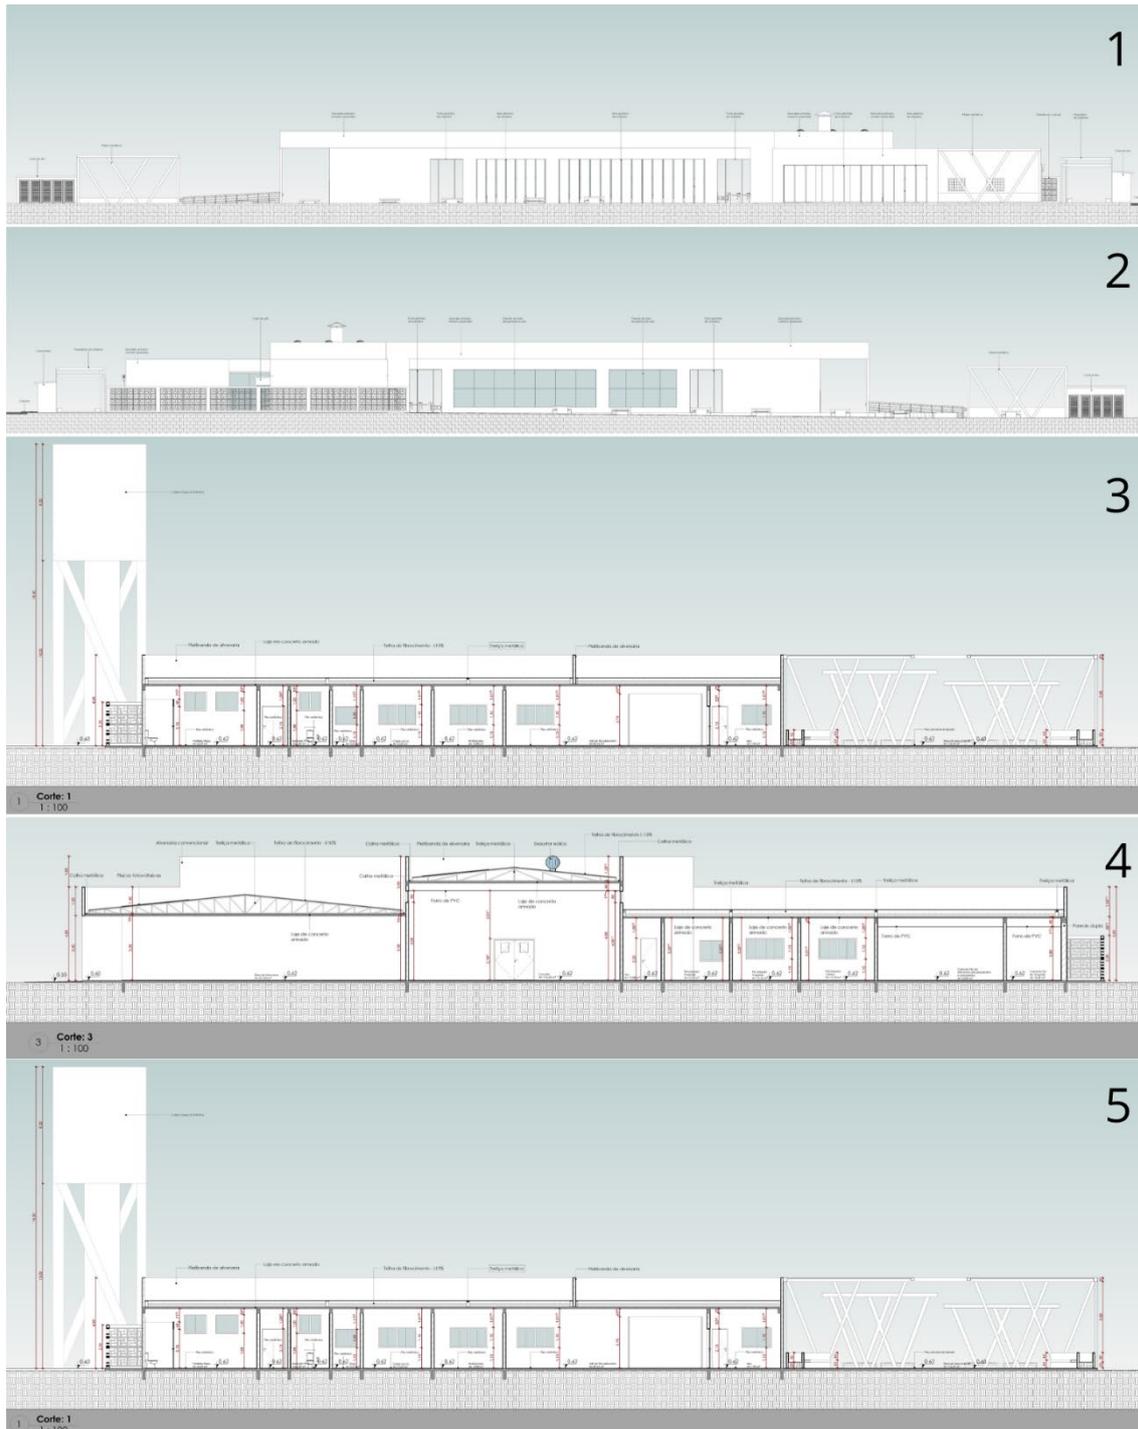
Elevações e cortes. Fonte: Autor 2024.
